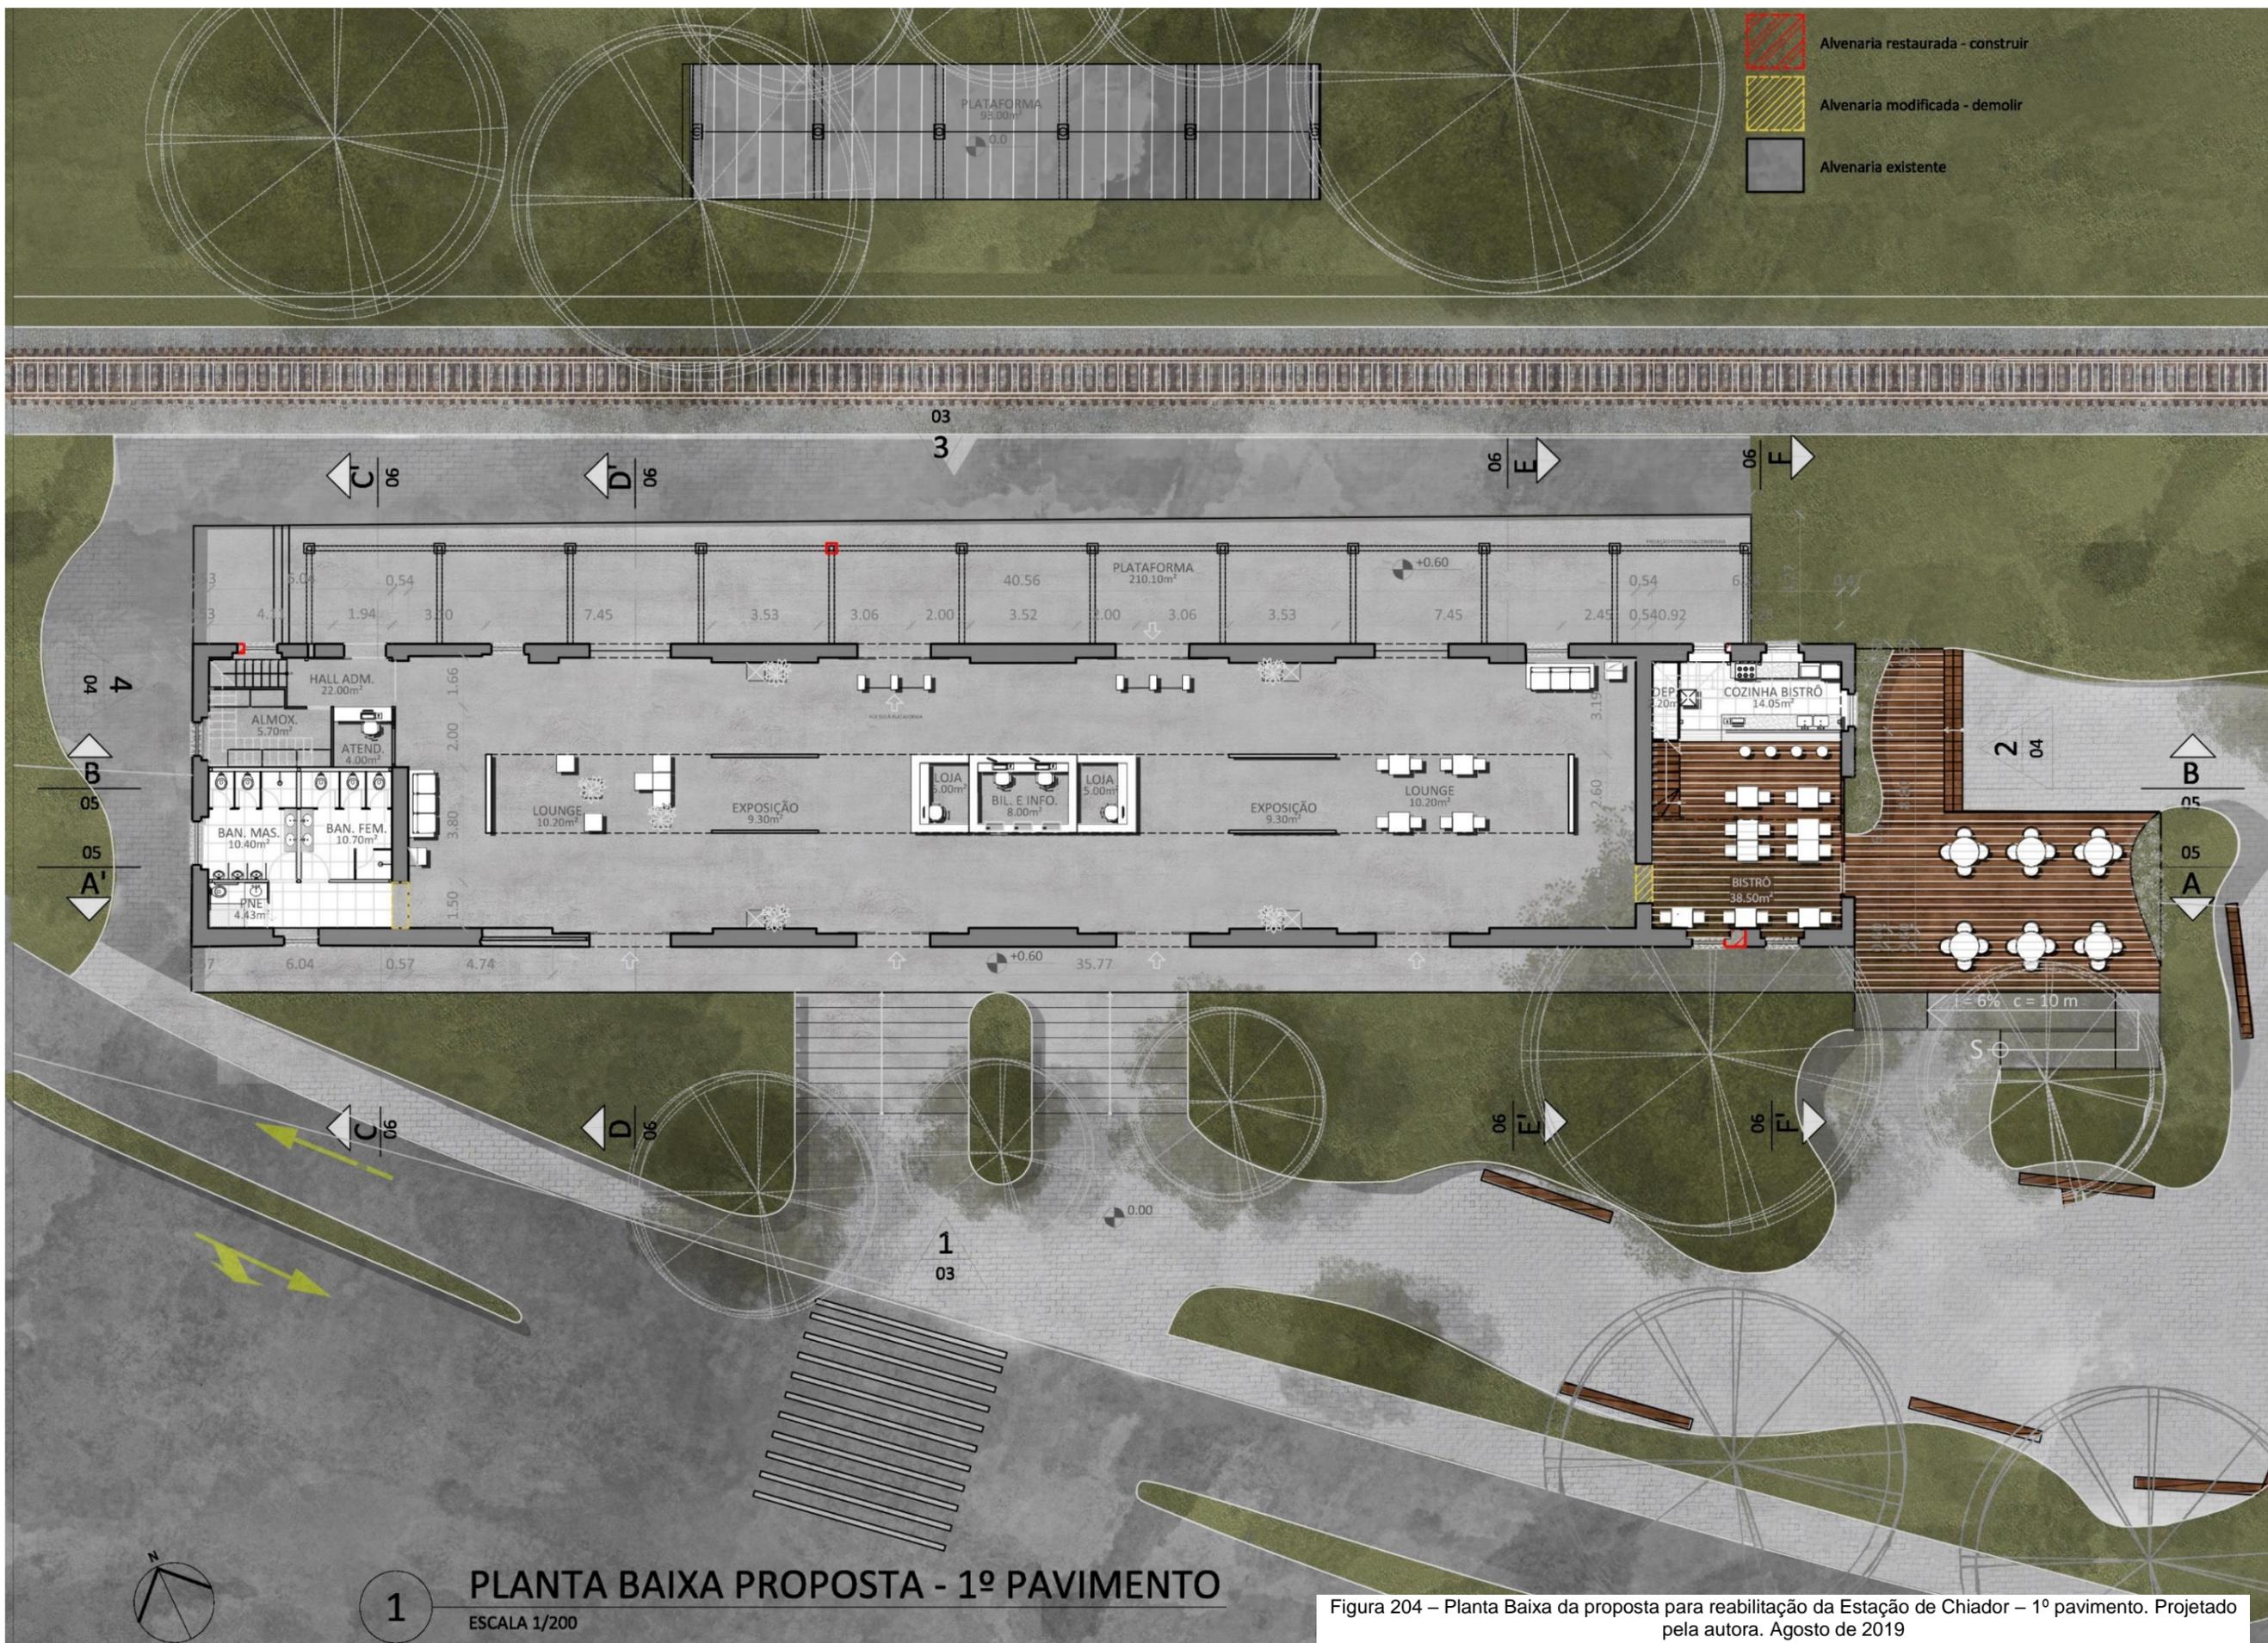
Planta Baixa da proposta para reabilitação da Estação de Chiador – 1º pavimento. Projetado pela autora. Agosto de 2019
